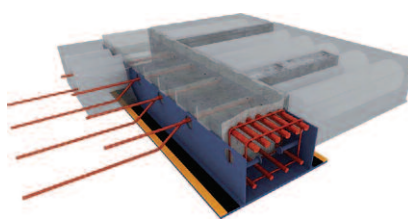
Połączenie ściany murowanej i elementu prefabrykowanego za pomocą szyny i kotew [5]
